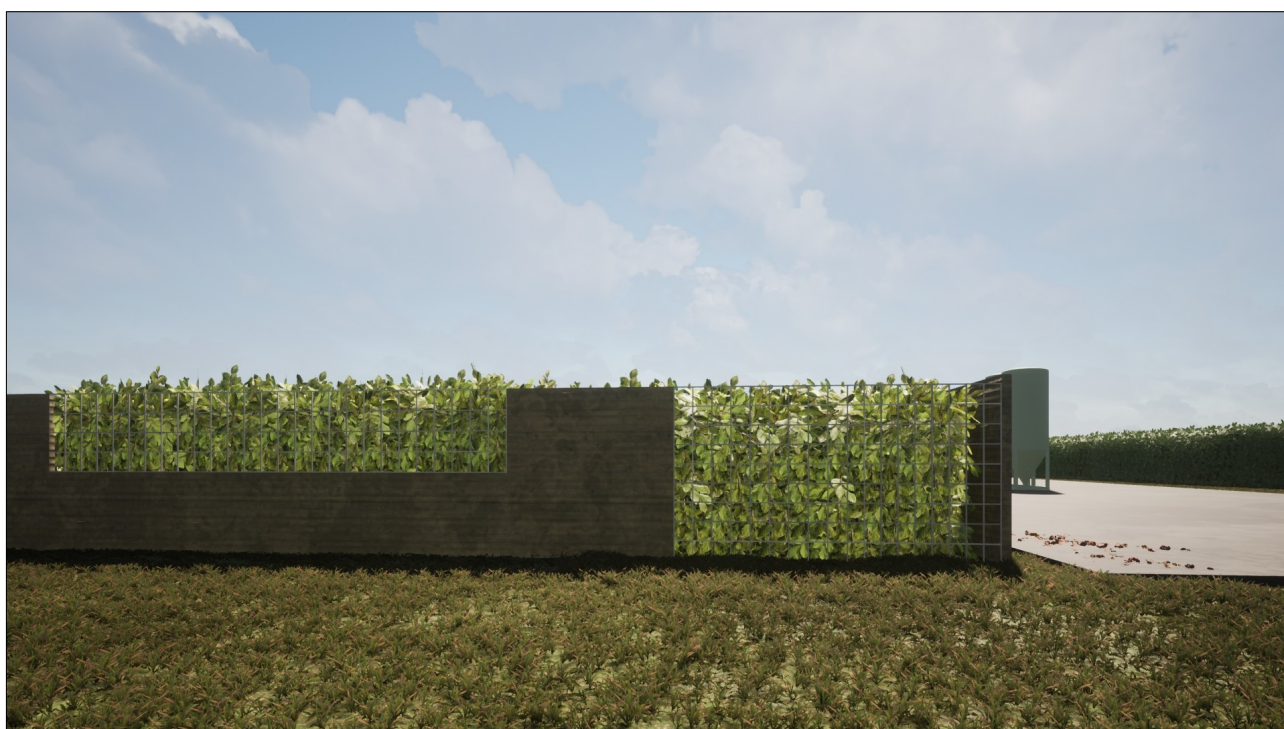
render della parete mascherante costituita da pannelli sandwich effetto "finto legno" e piante rampicanti
